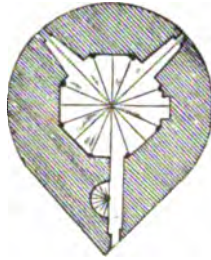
Fig. XLII. Plan de la tour Blanche d'Issoudun.
